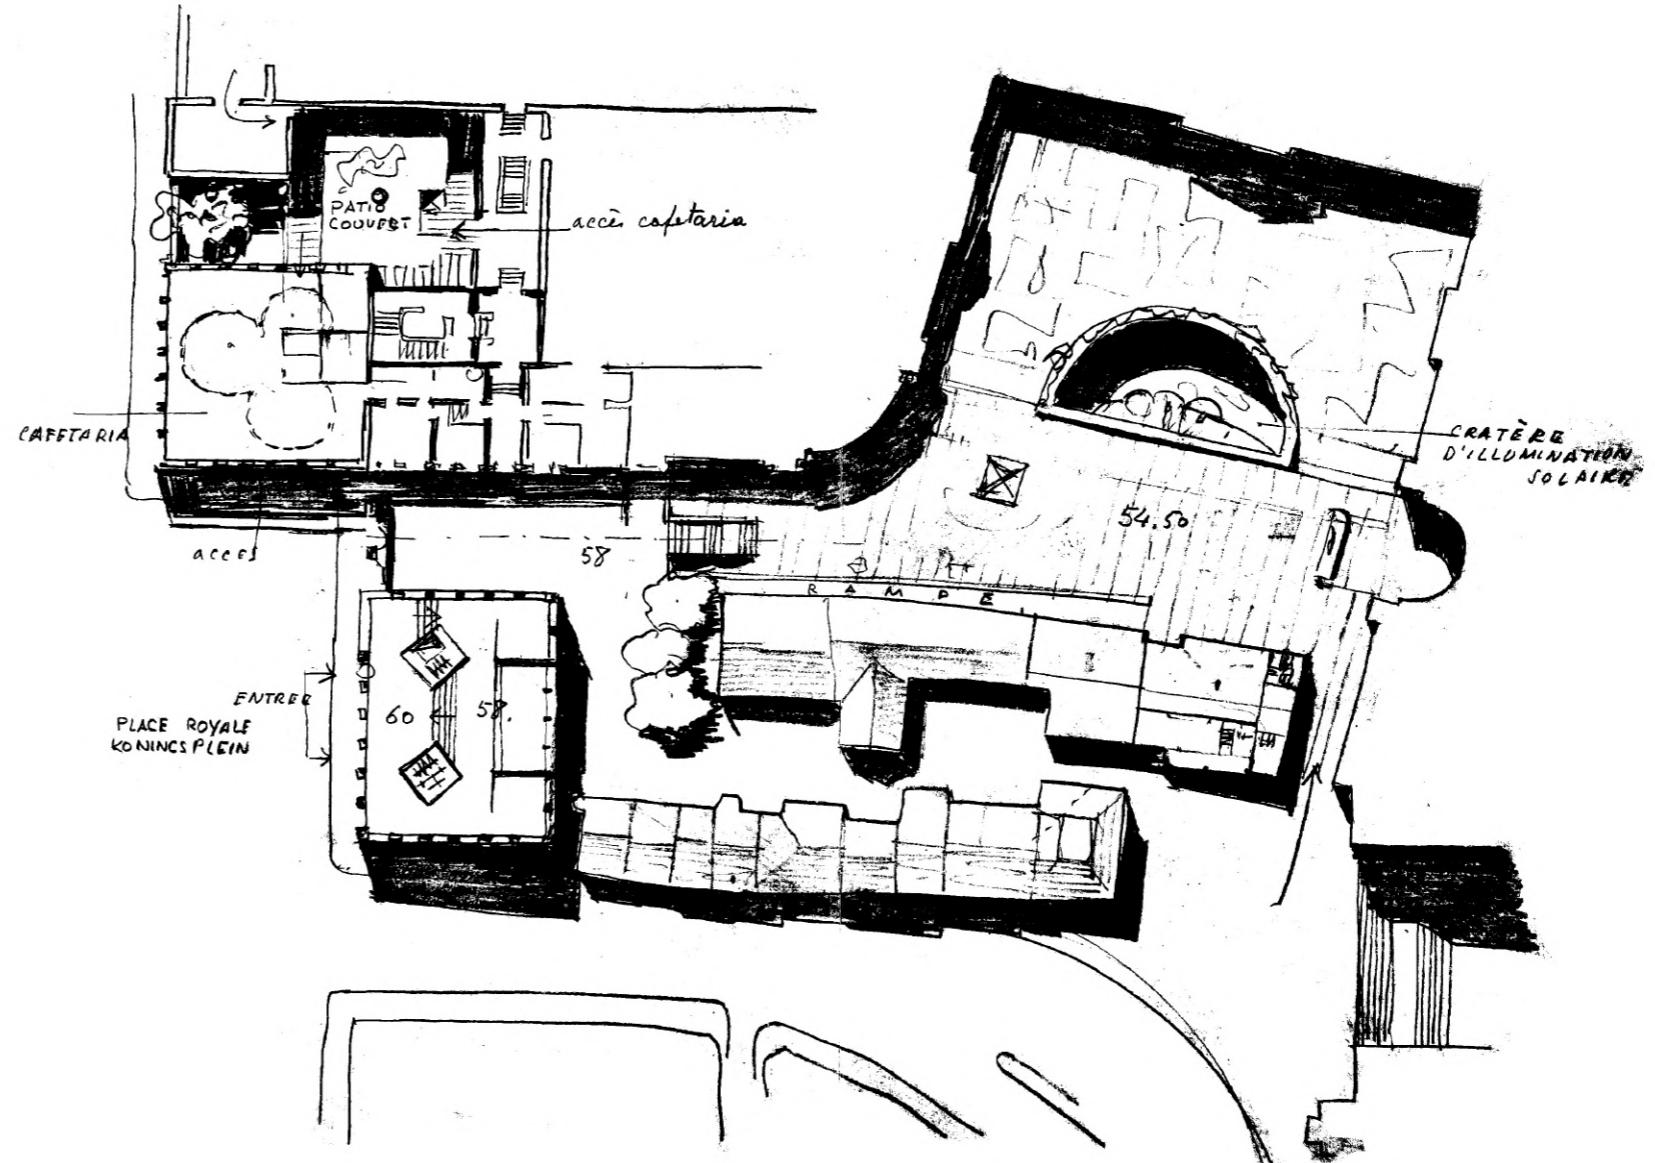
Plan de masse, ébauche du musée camouflé.
